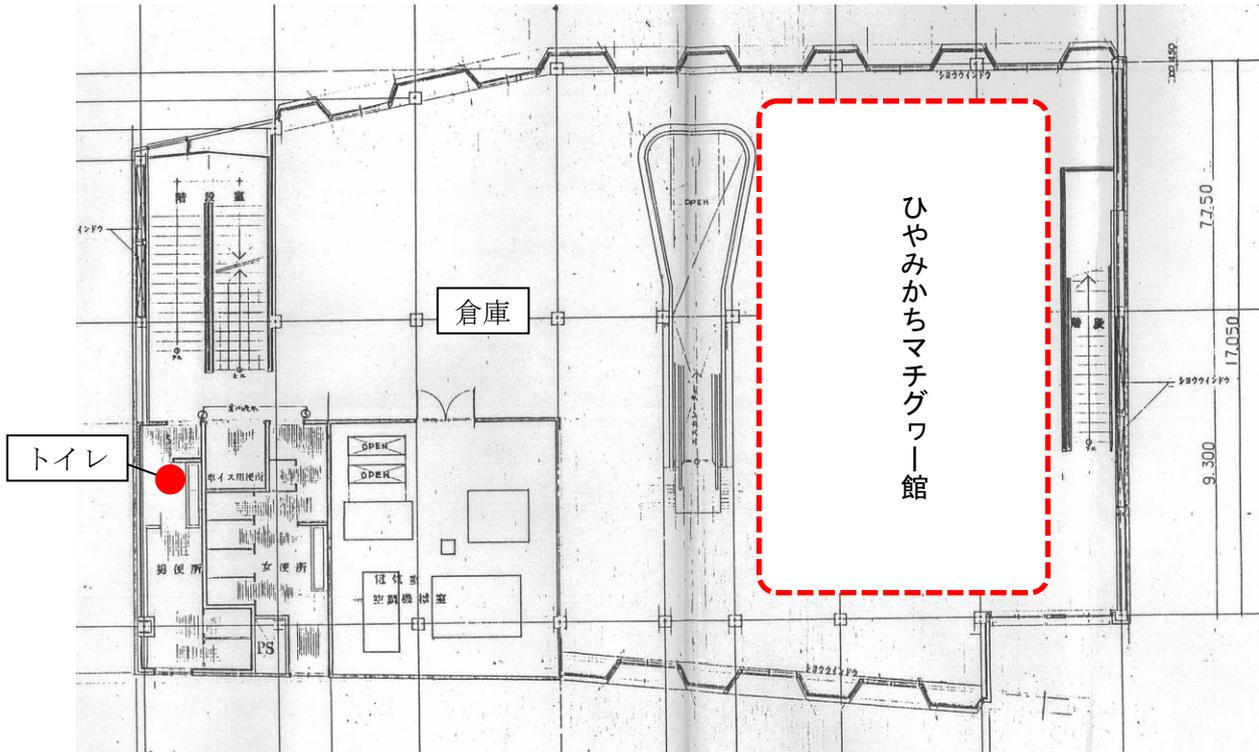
牧志公設市場（衣料部）の 2 階平面図
